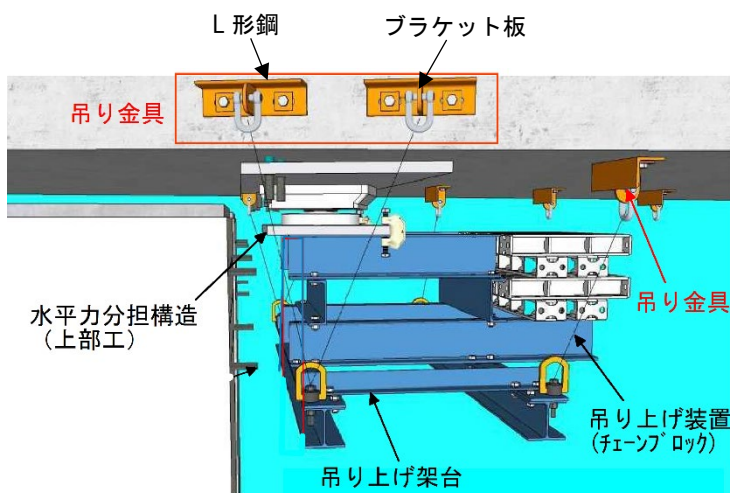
水平力分担構造（上部工）の設置状況のイメージ図
